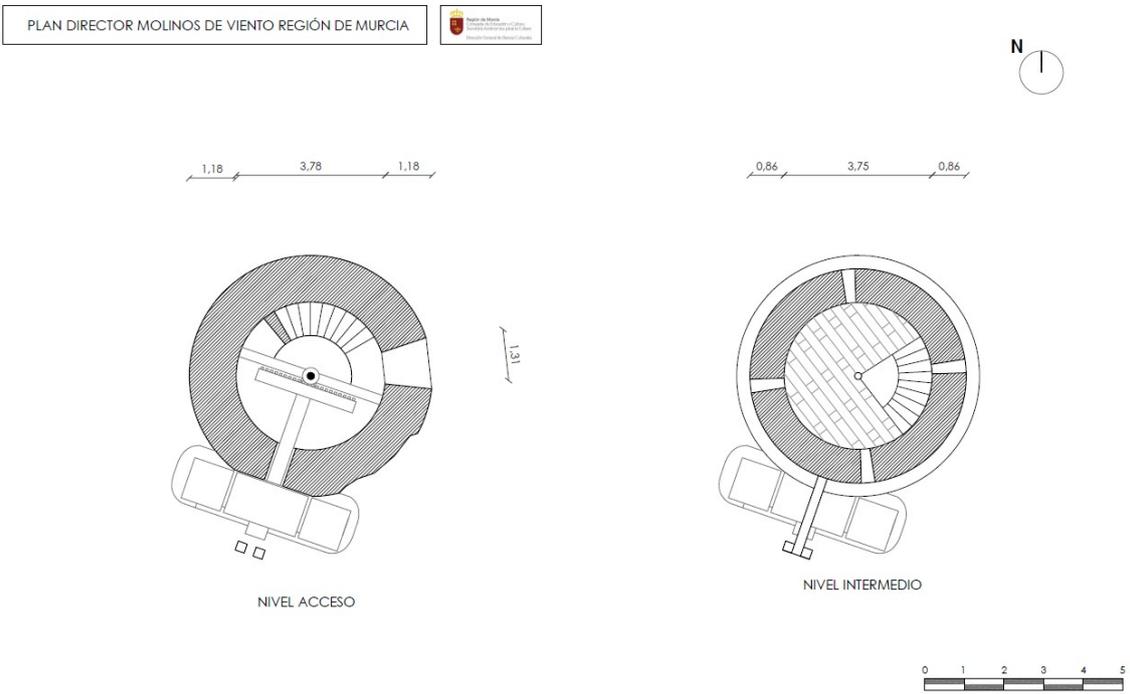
Ficha plano de plantas estado actual del molino de viento nº 025
